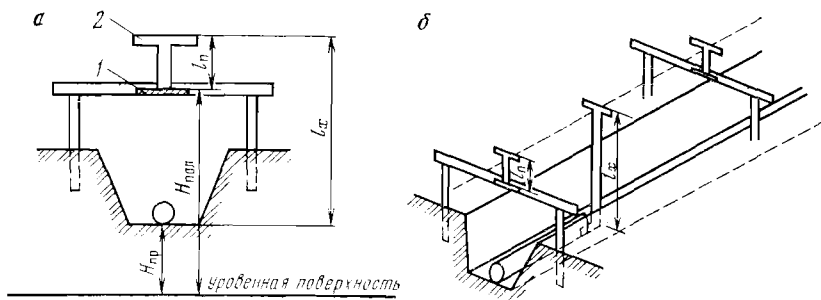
Схемы укладки трубопроводов с помощью постоянных и ходовых визирок
